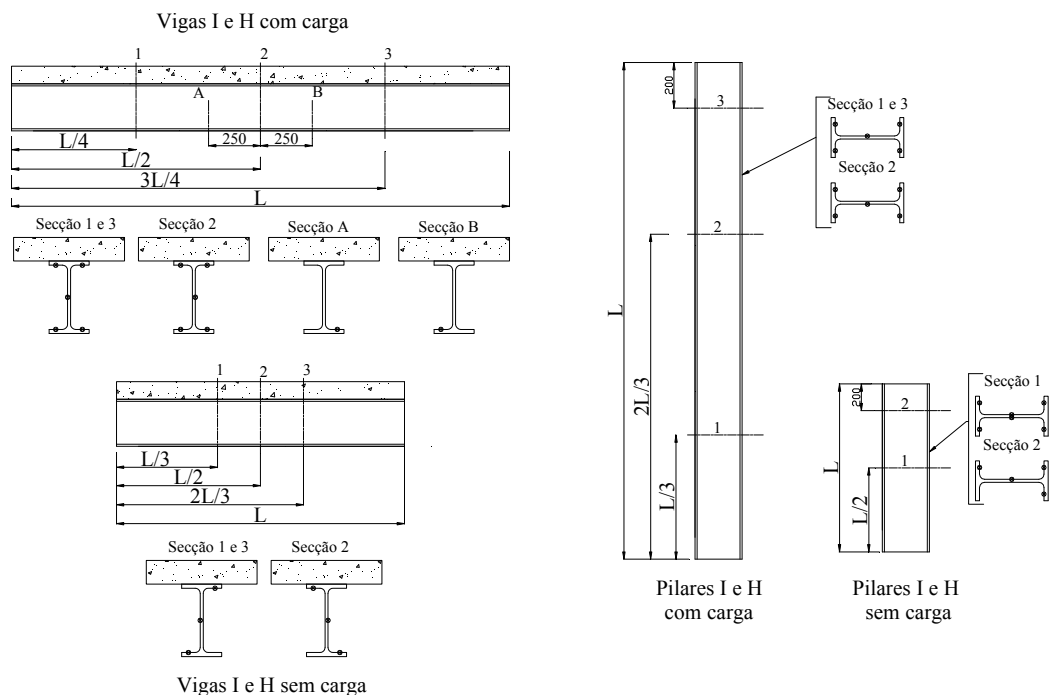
Localização dos termopares para vigas e pilares I ou H, com e sem carga.
